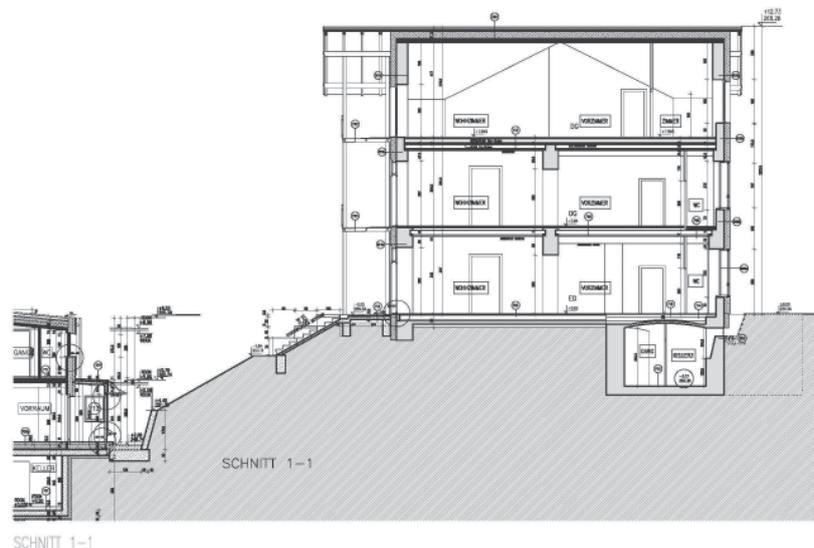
Schnitt Wohnhaus Purkersdorf Hiessbergergasse, Quelle: Architekt Reinberg
